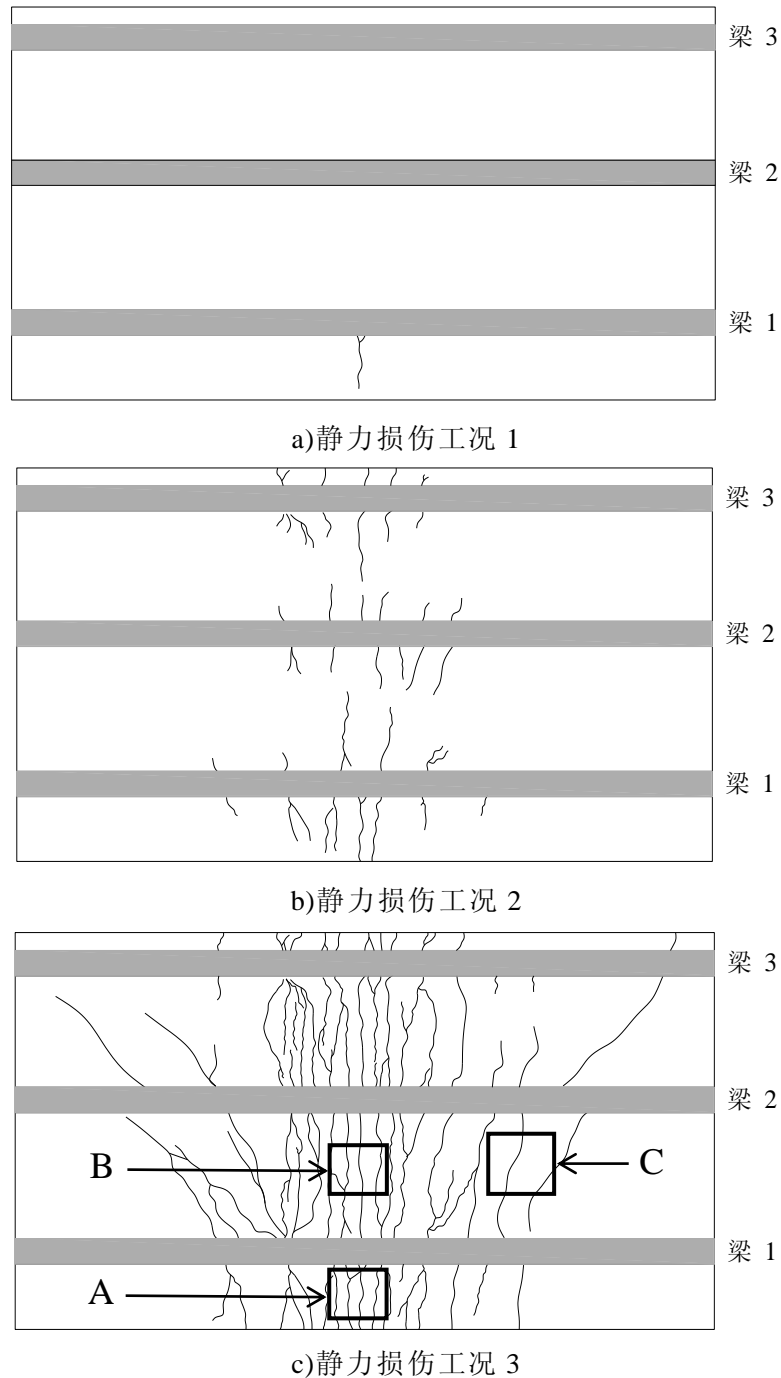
钢-混凝土组合板的裂缝开展
